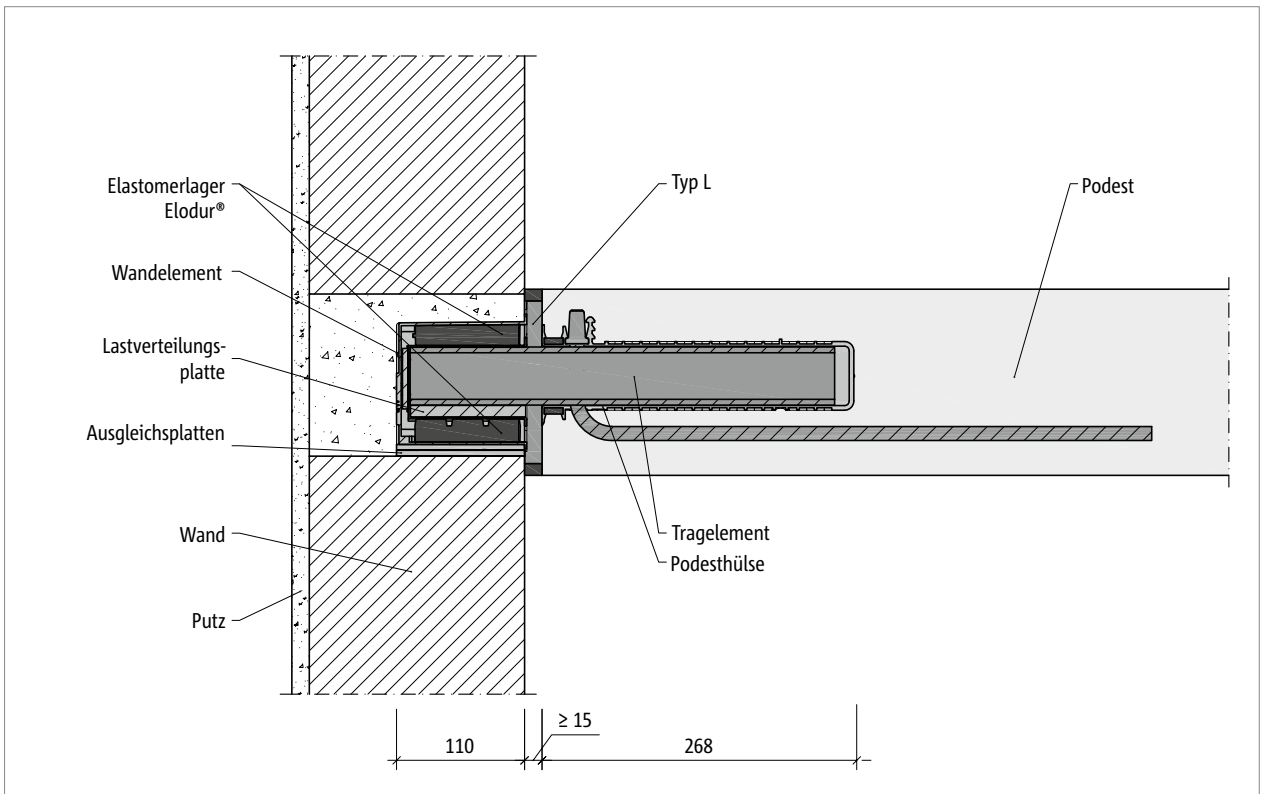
Schöck Tronsole® Typ P: Einbauschnitt mit Elementpodest und Tronsole® Typ L
